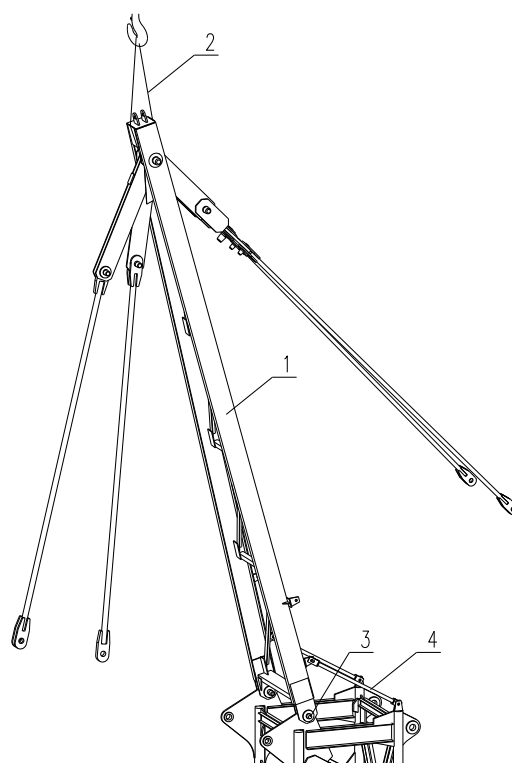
安装塔头 Fig. 4-17 Fitting tower head
